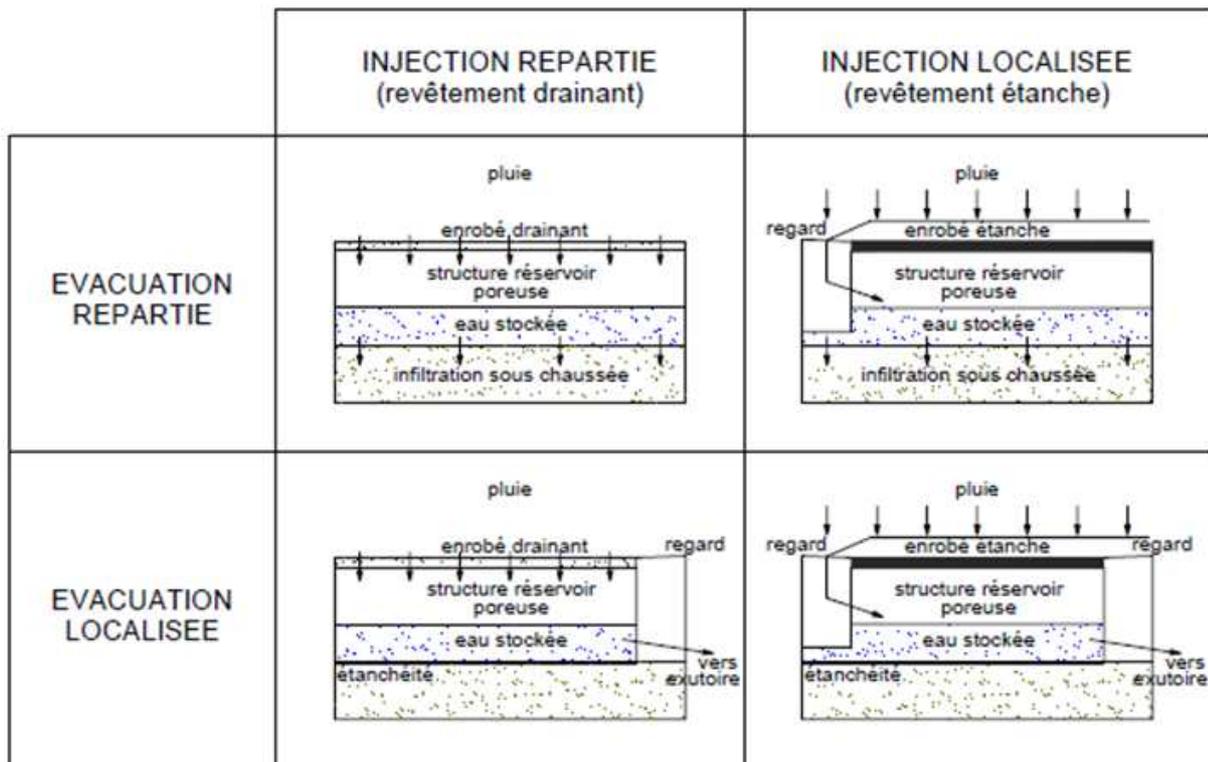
Schéma récapitulatif des différentes chaussées à structure réservoir1
